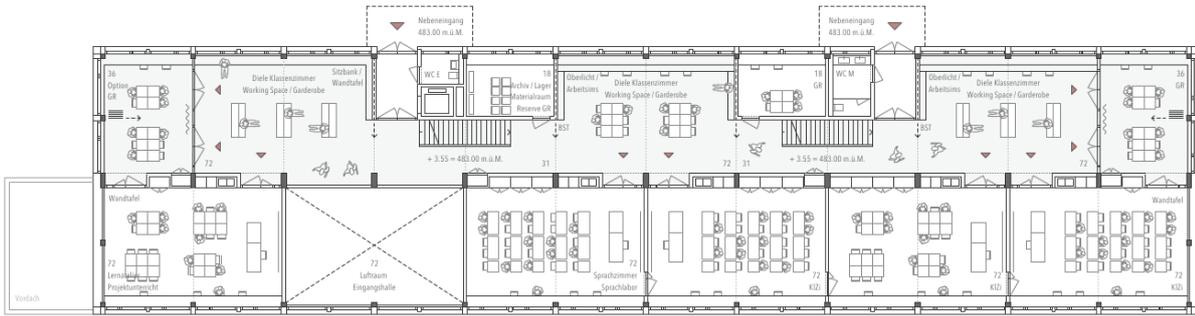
Neubau Sekundarschule, Grundriss 1. Obergeschoss
